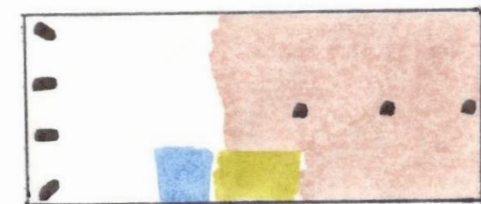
Construtora Khouri. A localização da circulação e do núcleo de serviços setoriza a planta do edifício, sendo aos fundos em planta livre.
